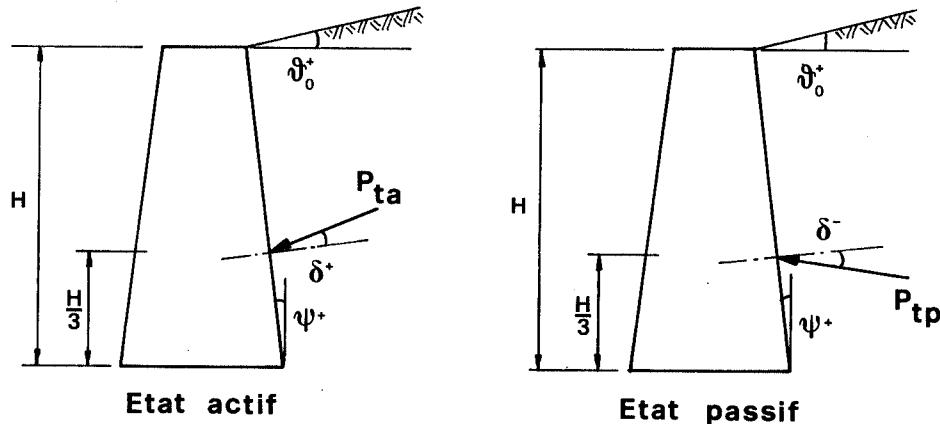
Poussées s'exerçant sur un mur de soutènement.
